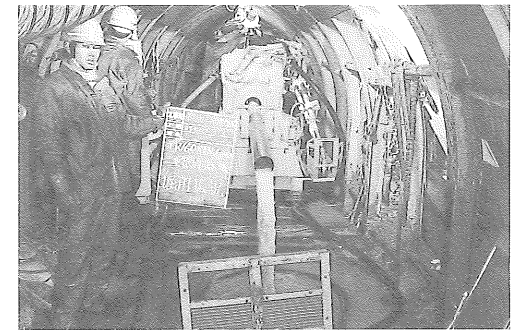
長尺先進ボーリング調査作業坑内での施工状況
